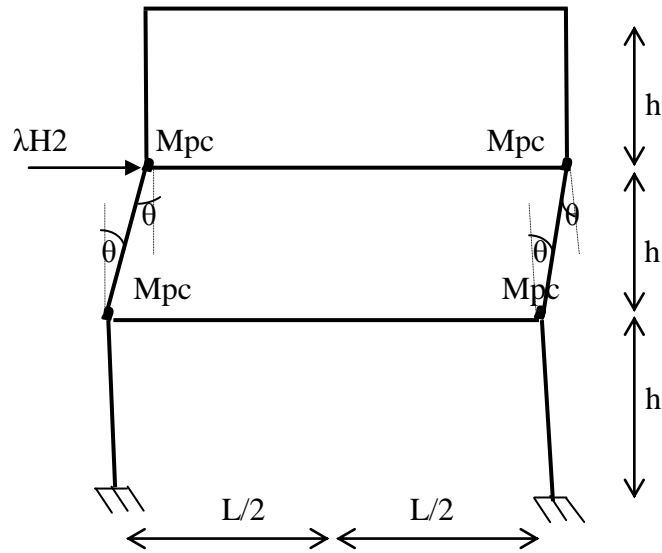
mécanisme N°5 des poteaux du 2eme niveau
